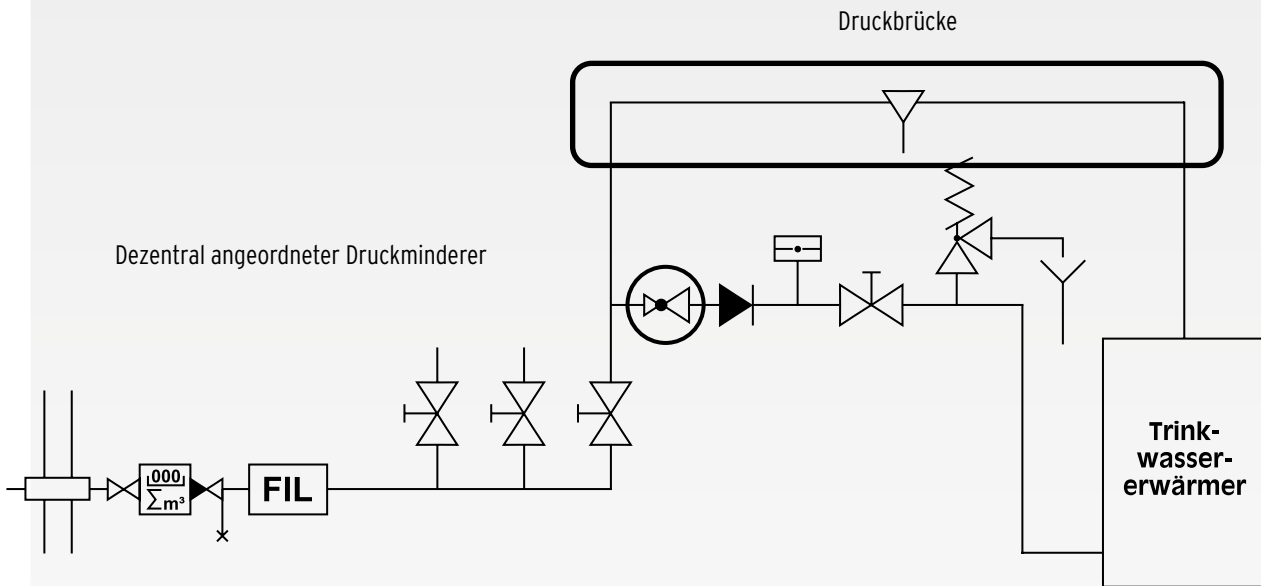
Druckbrücke vom Kaltwasser zum Warmwasser
